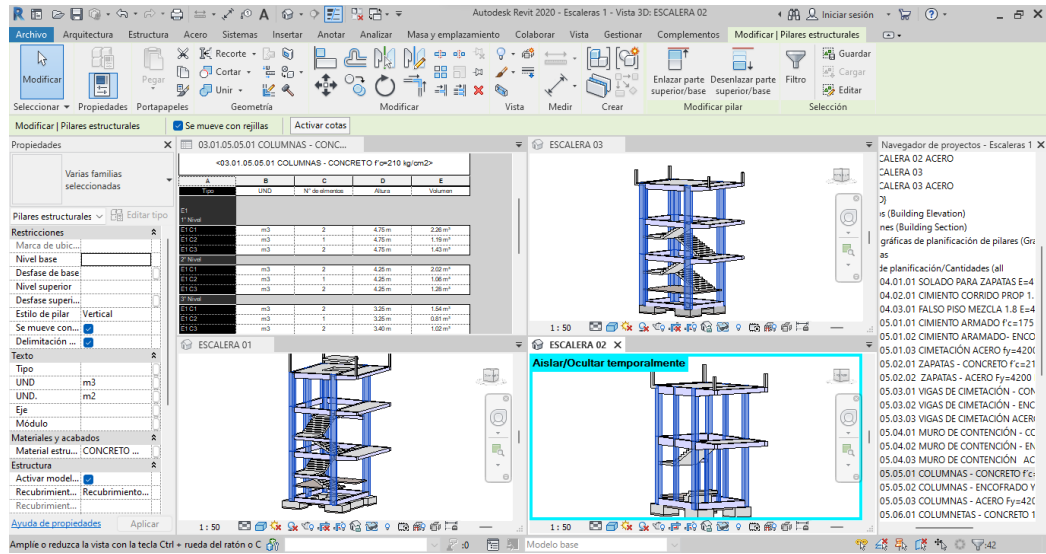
Modelado y metrados de la partida Columnas Modulo Escaleras.
